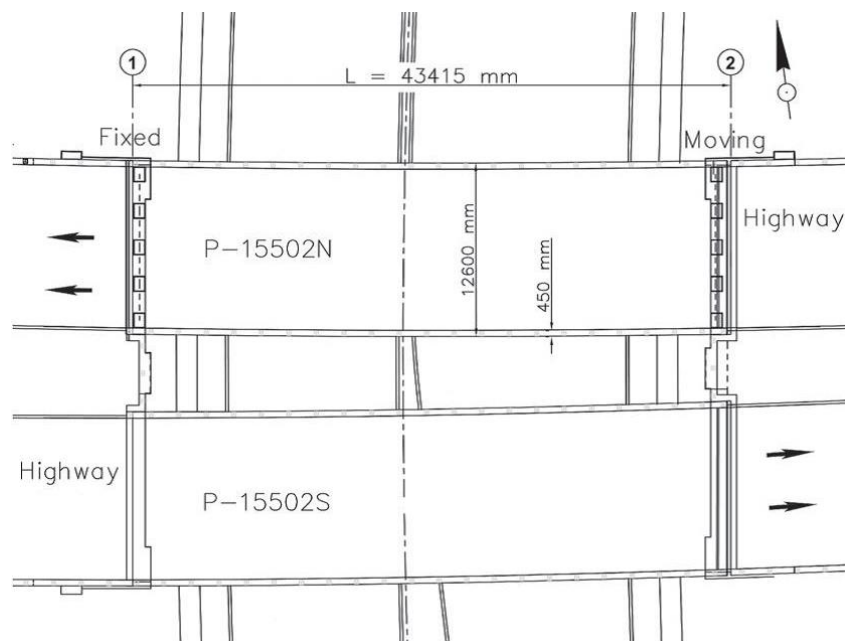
Planta puentes gemelos de Sainte-Catherine.
